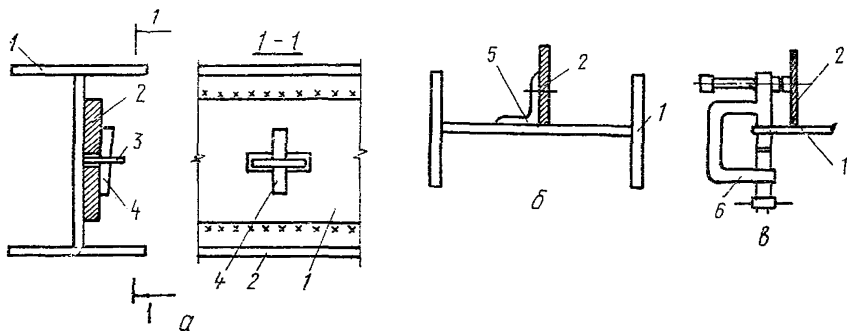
Приспособления для сборки и выверки конструкций усиления:
